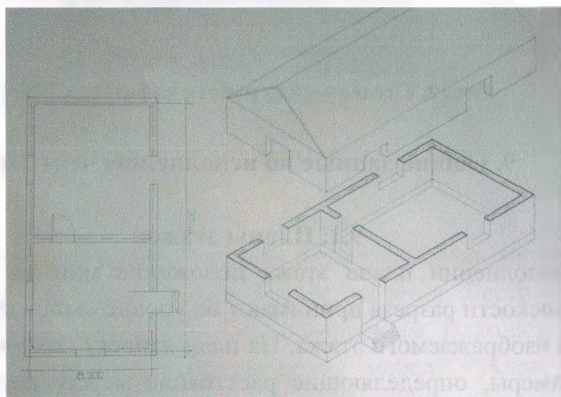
План жилого дома (горизонтальное сечение сооружения)
